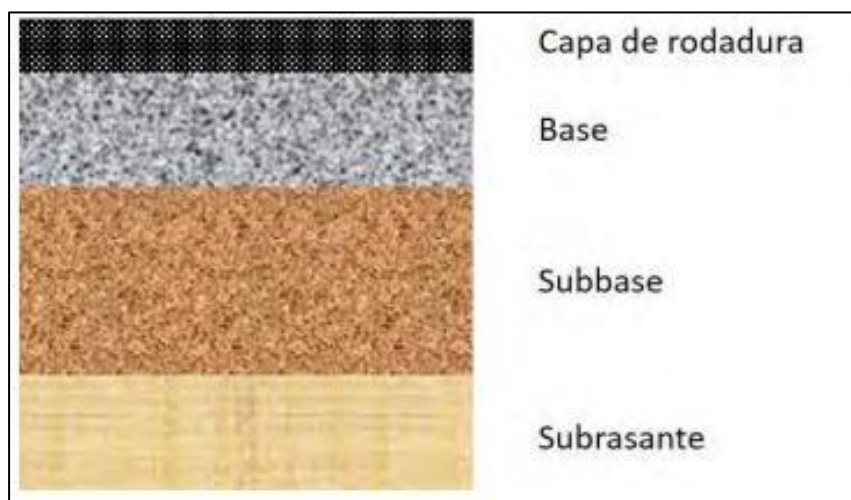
2 Esquema de la estructura de un pavimento flexible. Por Quezada 2017.
